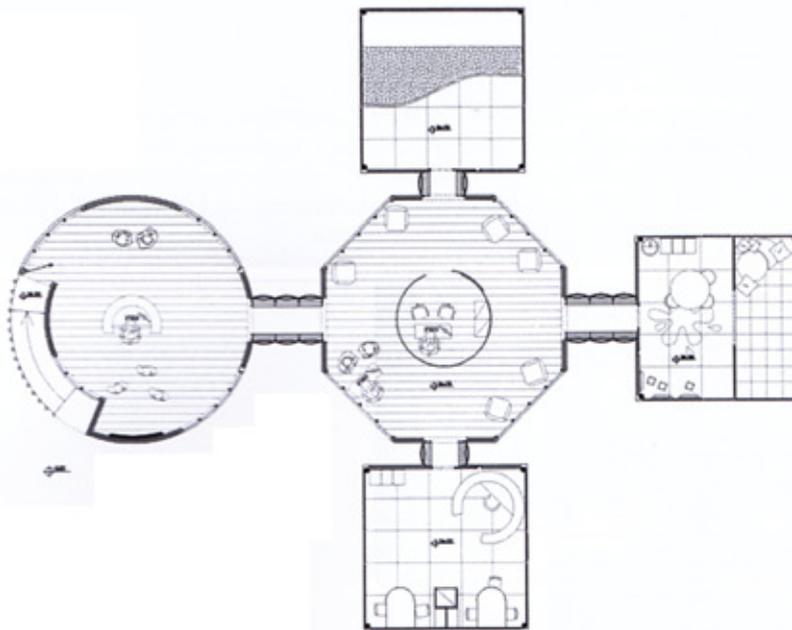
Progetto Myspace, pianta del sistema dei padiglioni (tratto dalla Tesi di V. Castiglione)
